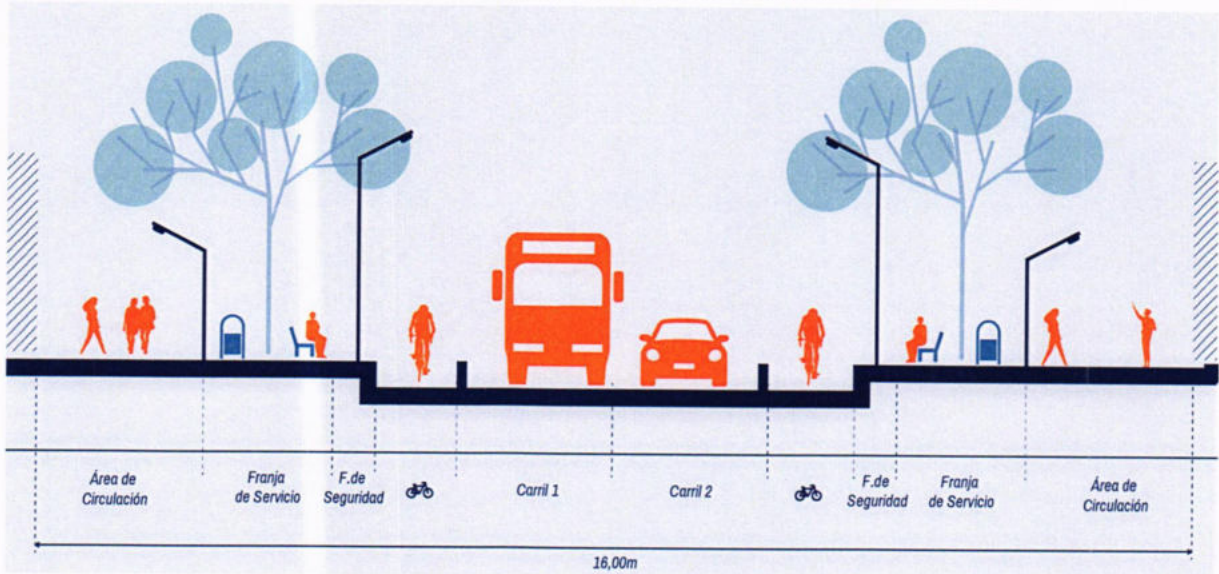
Vía interna transversal 7 (ViT7) del Plan Villanueva Fase 2A
